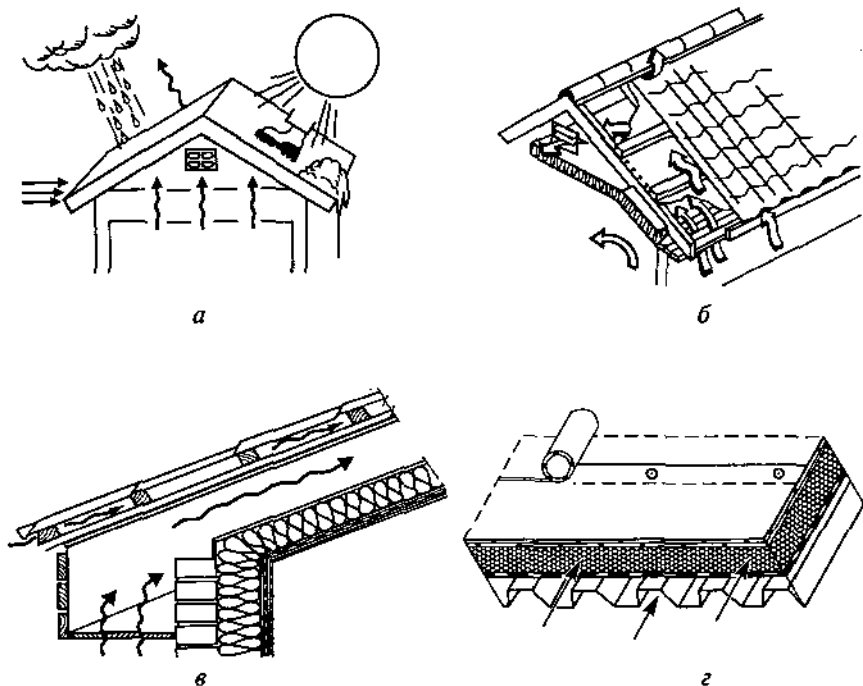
Факторы, воздействующие на кровельное покрытие:
